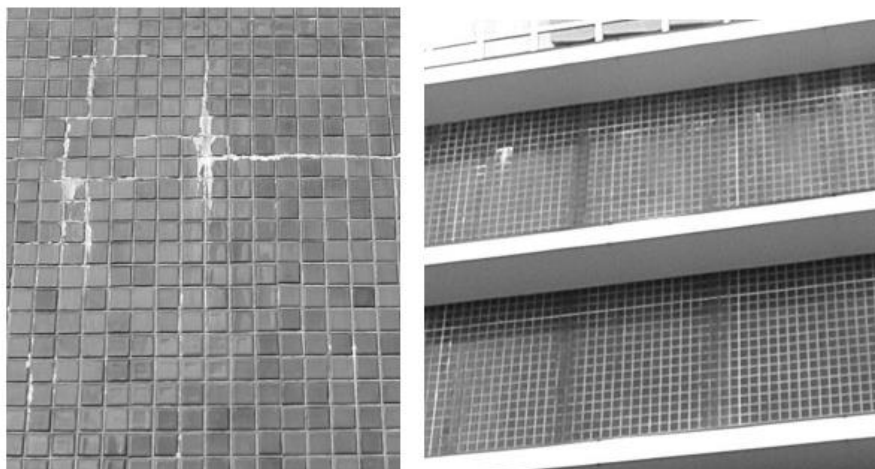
Fissuras causadas pelo recalque devido ao bulbo de tensões
